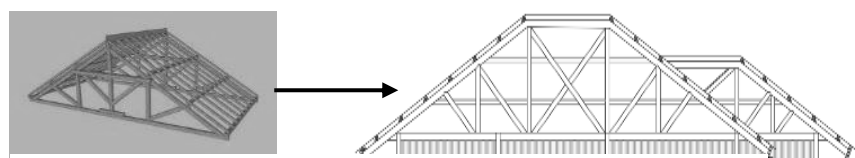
15 Konsep super structure bangunan kolom beton dan kolom kayu
